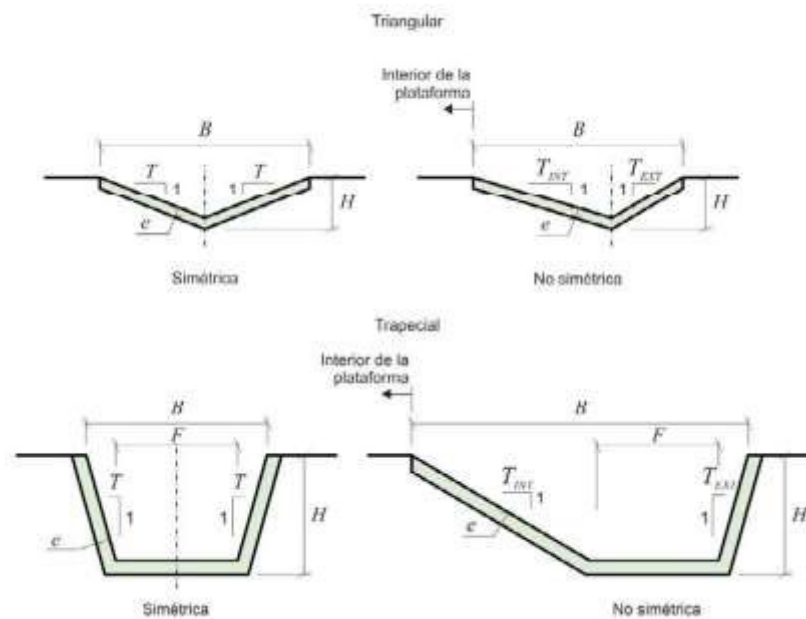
Tipo de cunetas/ Instrucción 5.2.1.C
